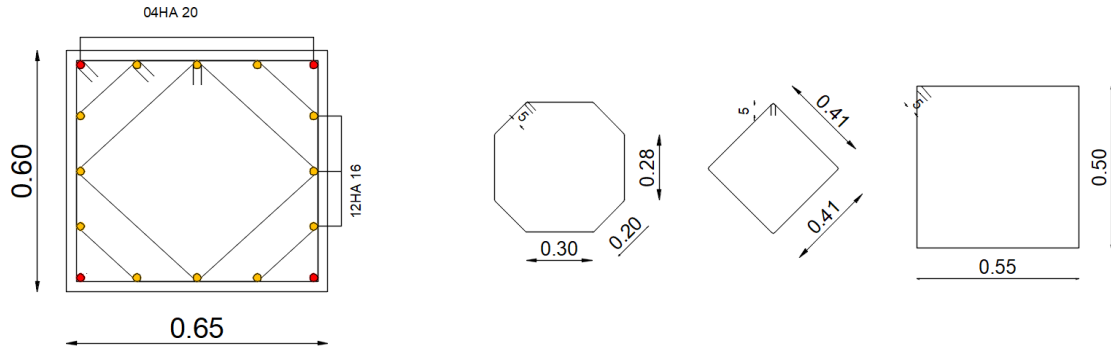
Schéma de ferrailage du poteau (70 x 70 cm<sup>2</sup>)
